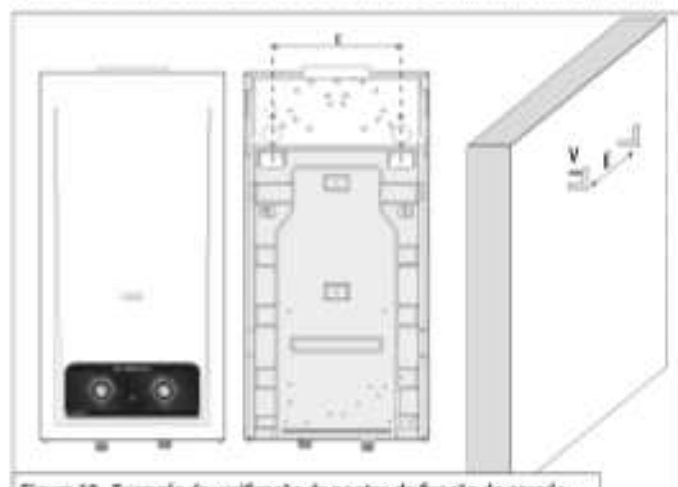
Exemplo de verificação de pontos de fixação de parede.
